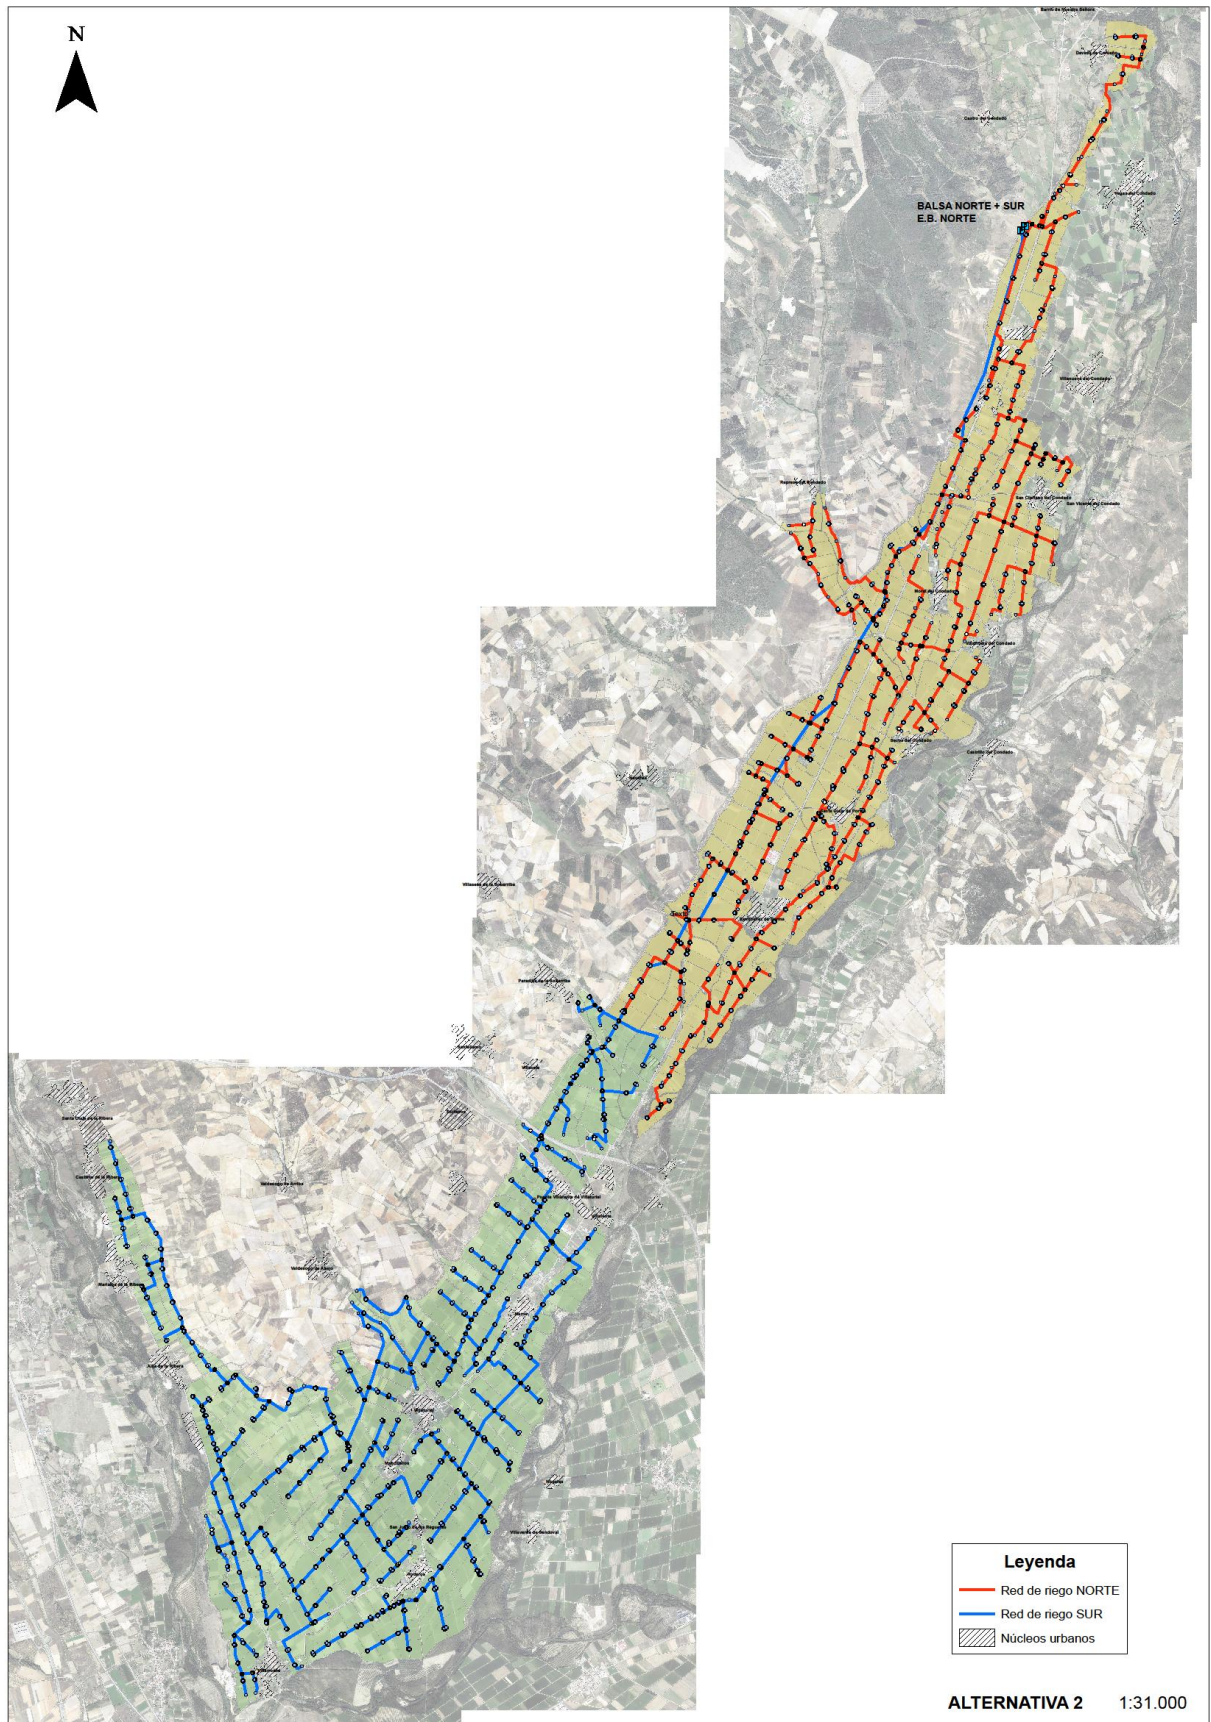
Ubicación de las infraestructuras en la Alternativa 2
